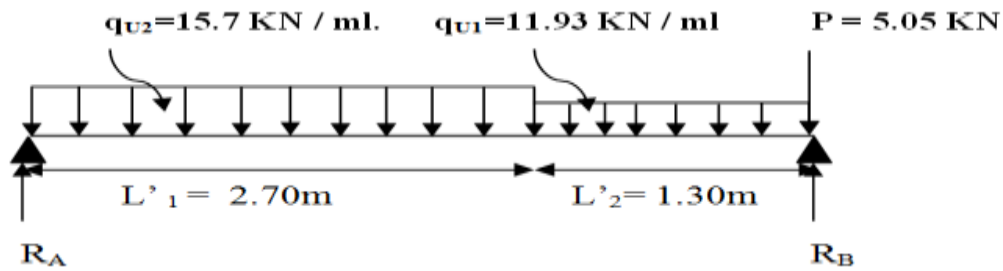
Schéma statique d'escalier à l'ELU
